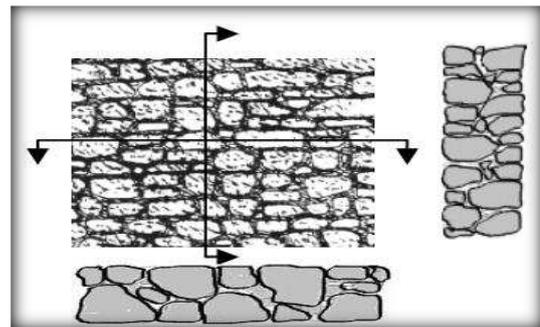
Structure maçonnée en pierre taillée avec liant hydraulique au mortier de chaux sable.
